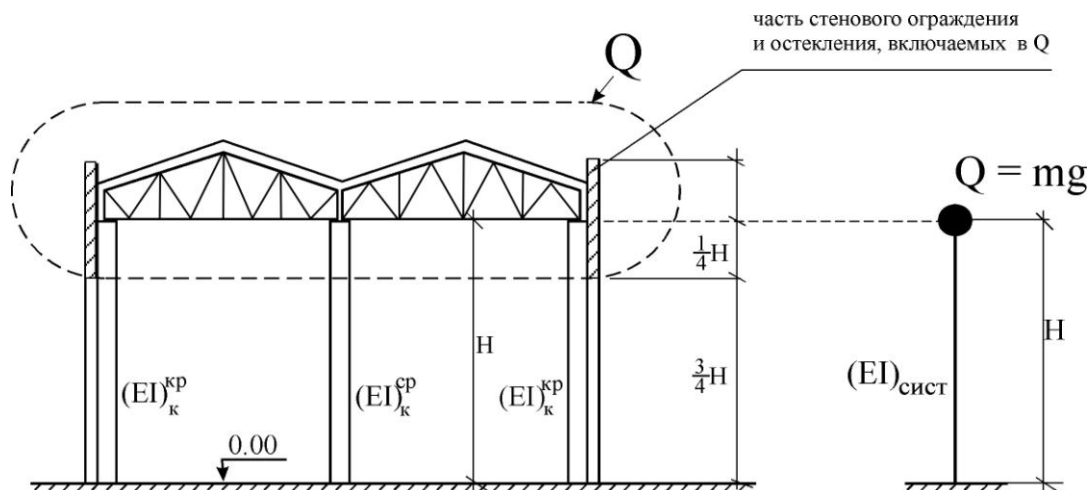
Формирование динамической расчетной схемы при шарнирном сопряжении стропильной конструкции с колоннами
